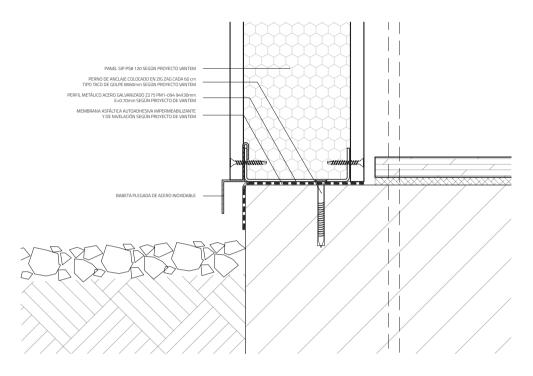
DETALLE 5: FIJACIÓN DE PANELES A CONTRAPISO.
